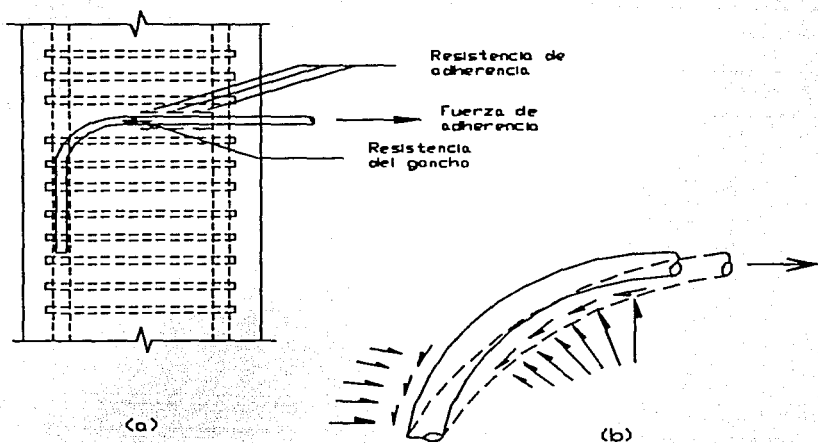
Anclaje de varillas de viga con ganchos a 90° .
